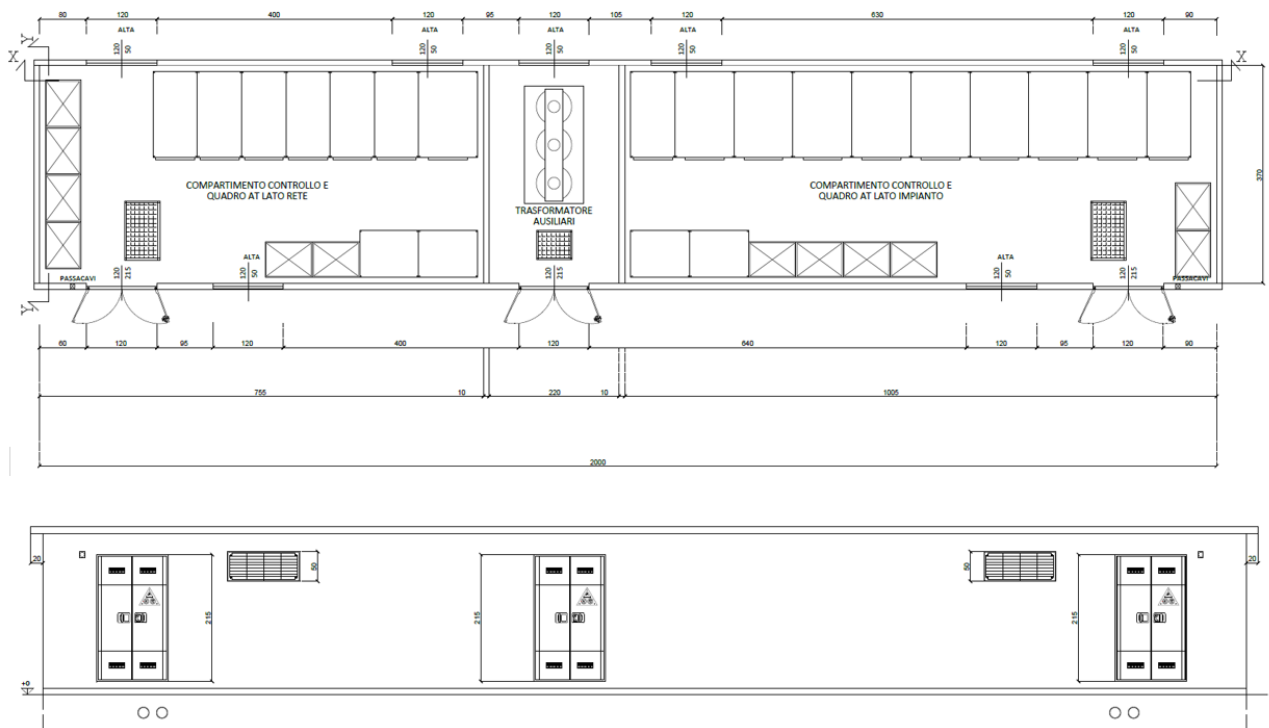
Pianta, Prospetti e Sezioni Cabina di Raccolta
